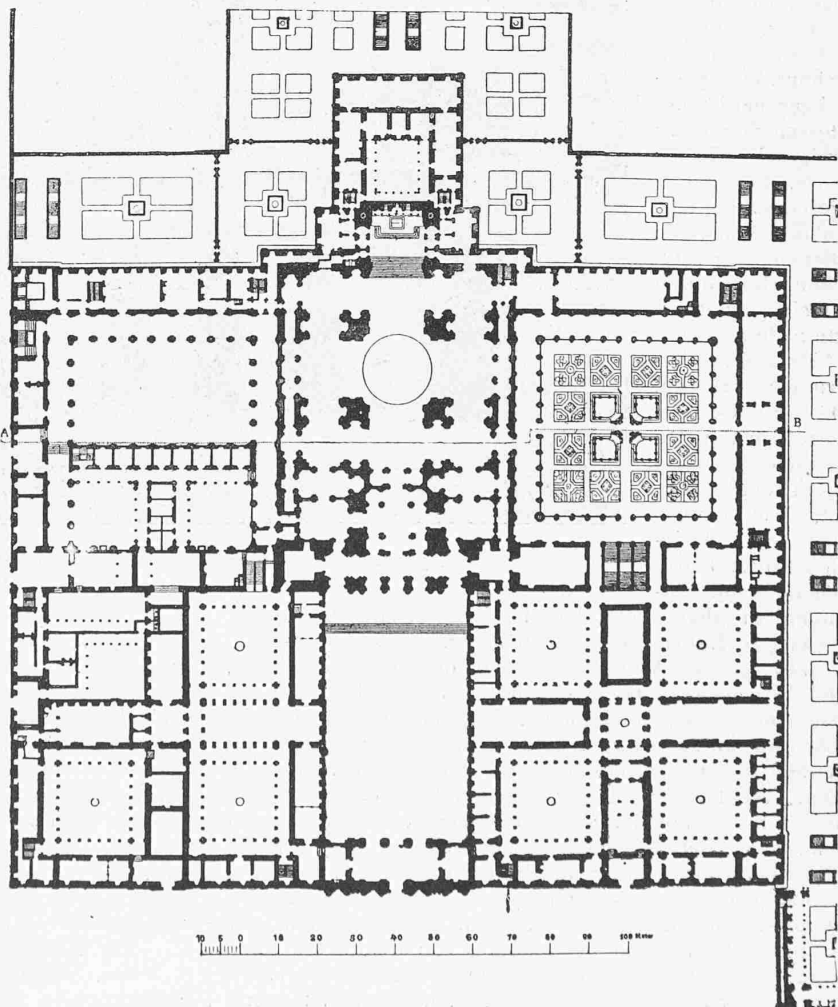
Grundriss des Escorial, nach Petrus-Perret. — Masstab 1:1750.
